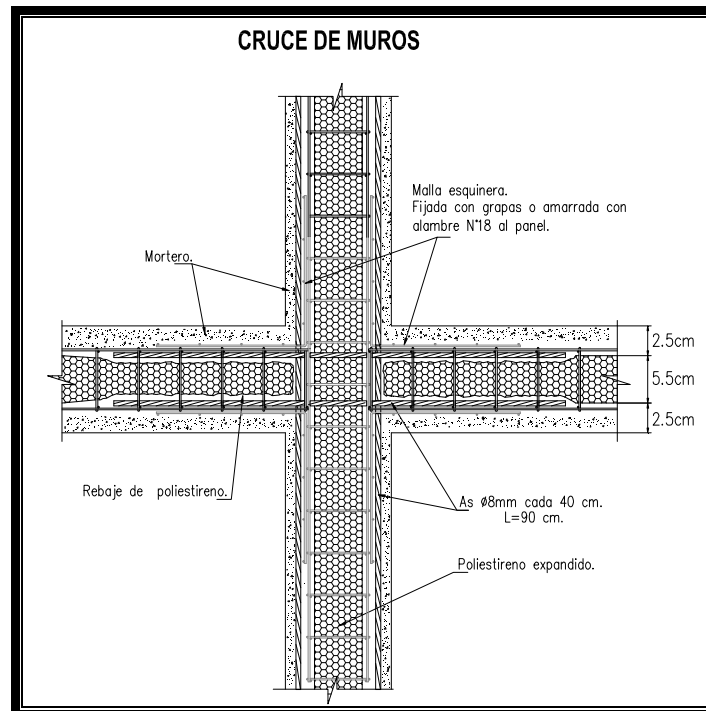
Detalle de armado de acero de refuerzo en cruces de muros
